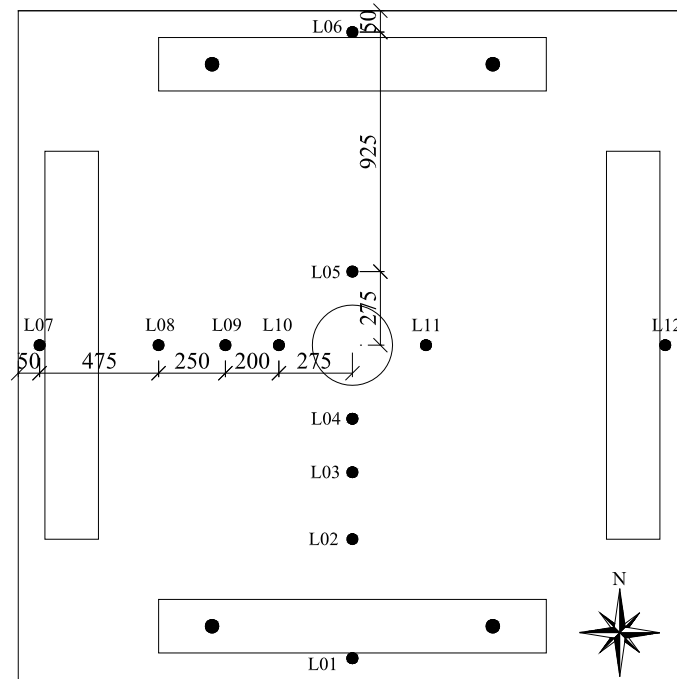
Detalhe de posicionamento dos LVDT's na superfície superior das lajes (cotas em mm)
